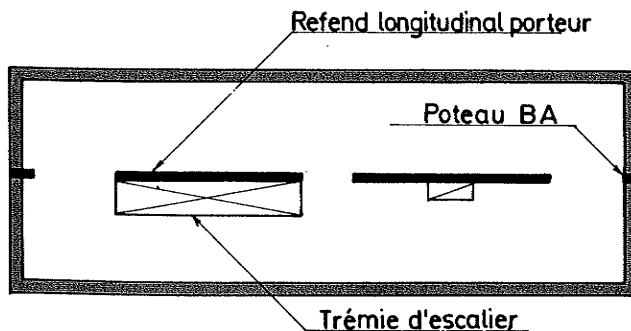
Plancher reposant sur murs extérieurs et un retend.
